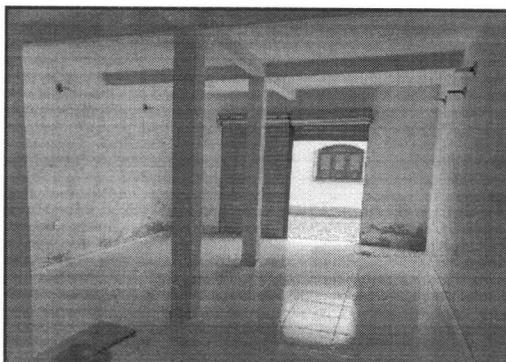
Vista do Salão Central, com piso revestido em cerâmica
